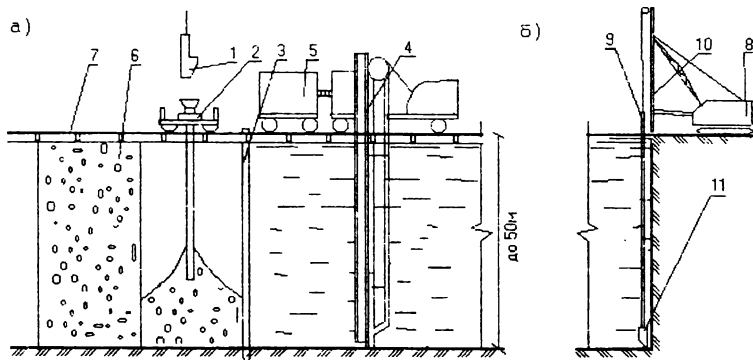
Схема возведения "стен в грунте" из монолитного железобетона.
